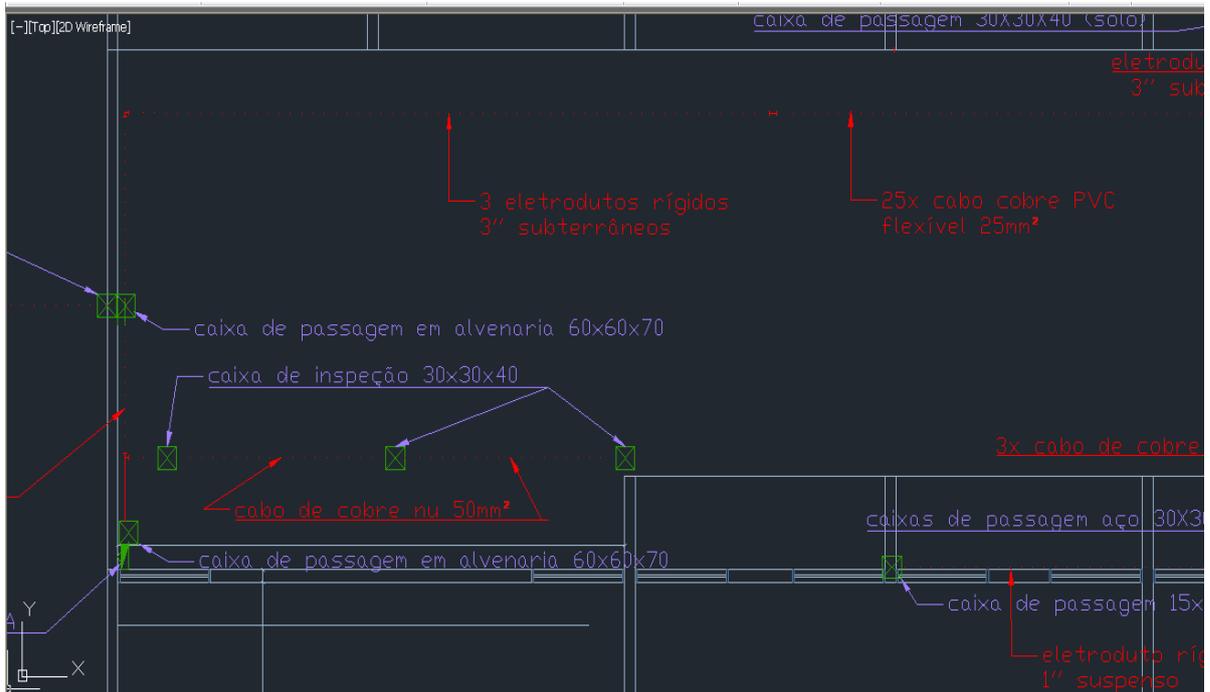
Planta baixa ao término do projeto elétrico João Pessoa, detalhe
